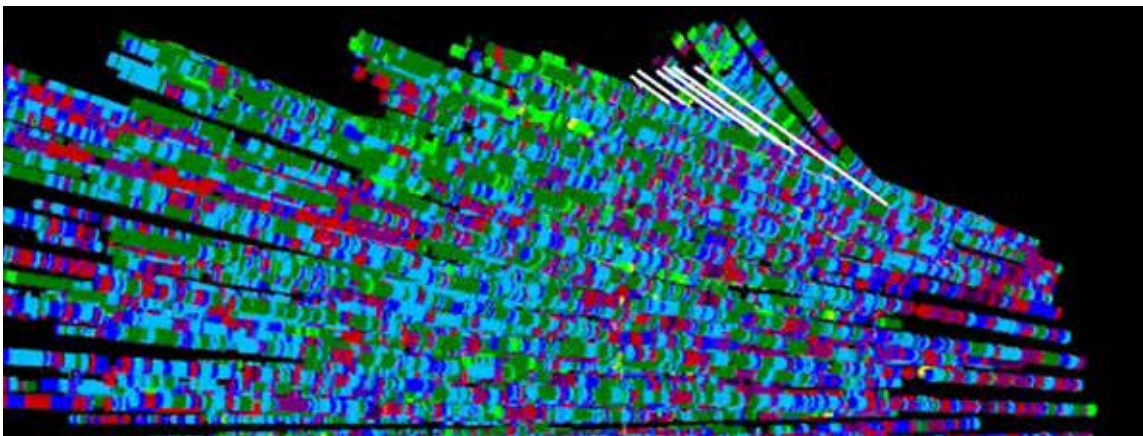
Målrettet sonderboring med god oppfølging kan avsløre svakhetssoner som kommer ned bakfra
